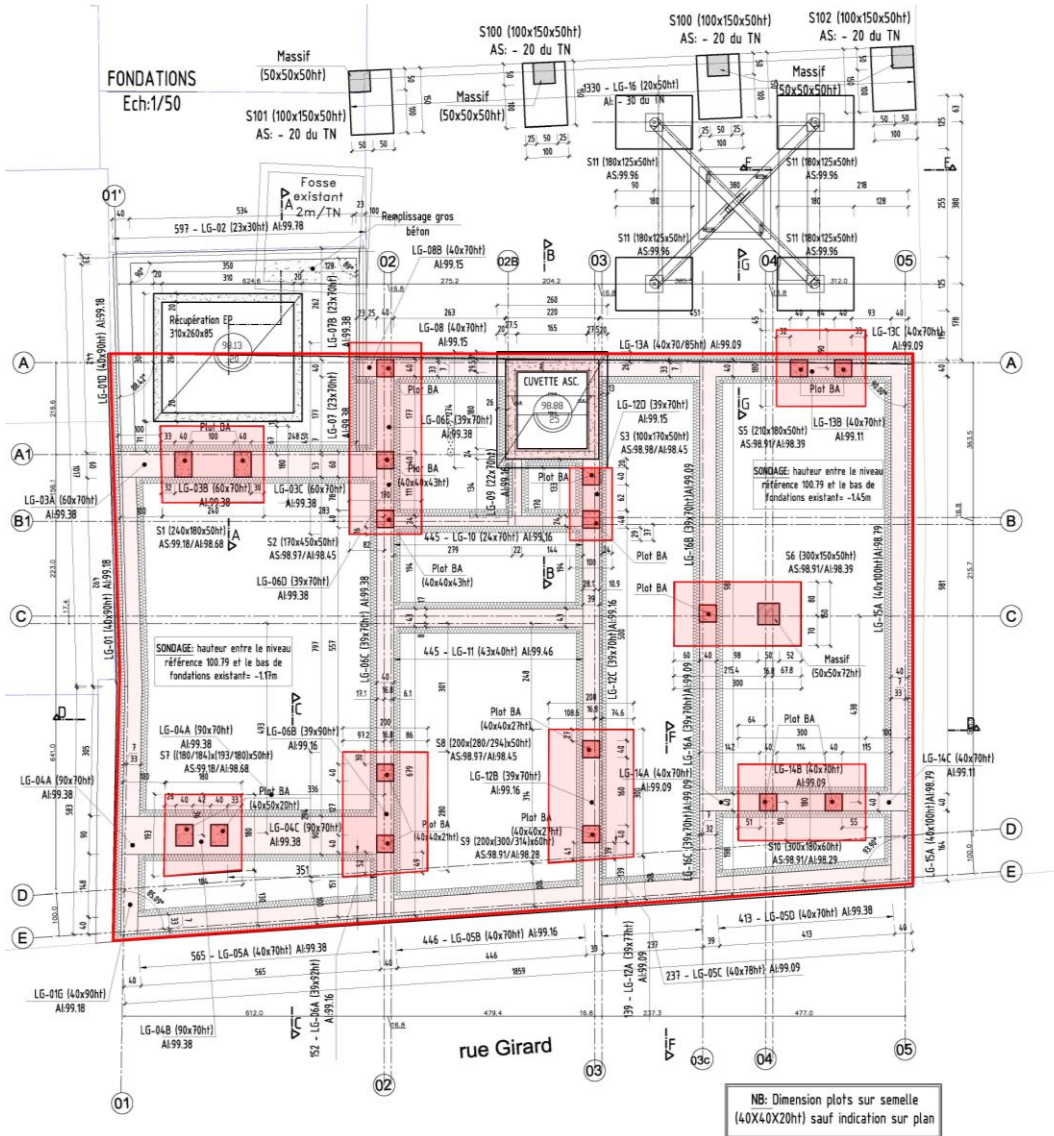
vue en plan fondations \_ 19 ponts thermiques ponctuels sur dalle + longrines isolées
